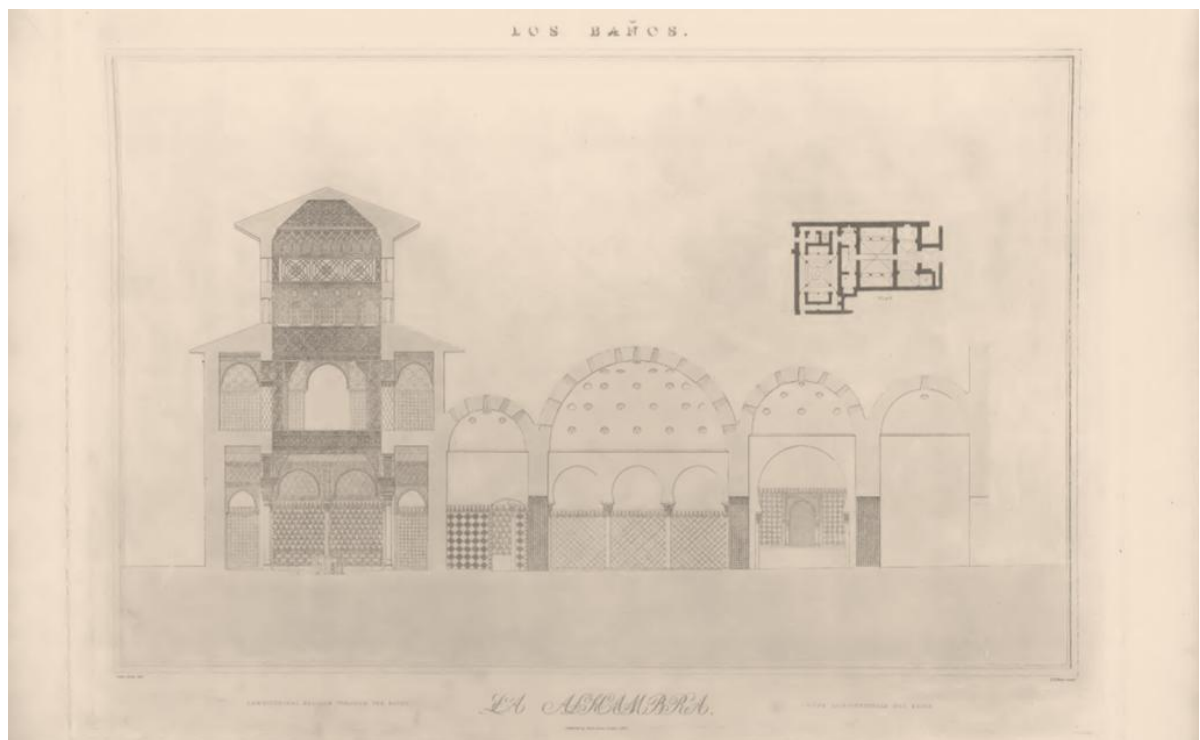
Los Baños. Owen Jones (1834) Plans and elevations, sections and details of the Alhambra (1836).Vol.I. Plate XXVI.
